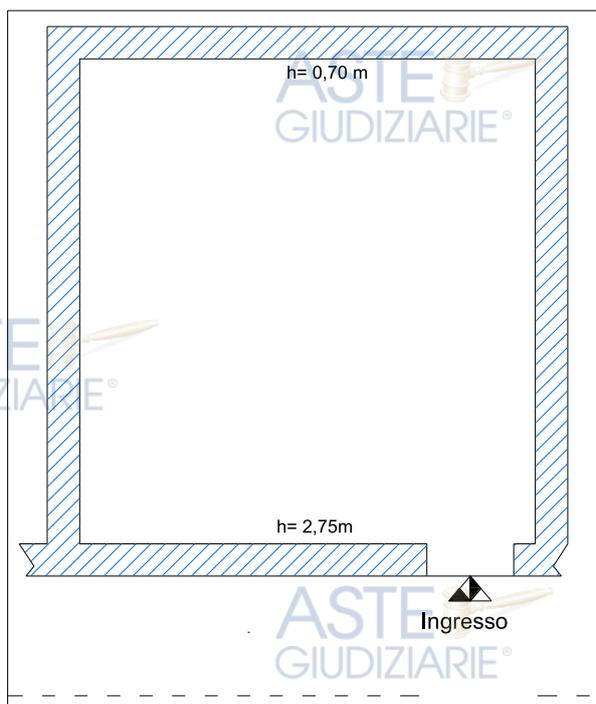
Pianta della soffitta associata all'appartamento di figura 5.
